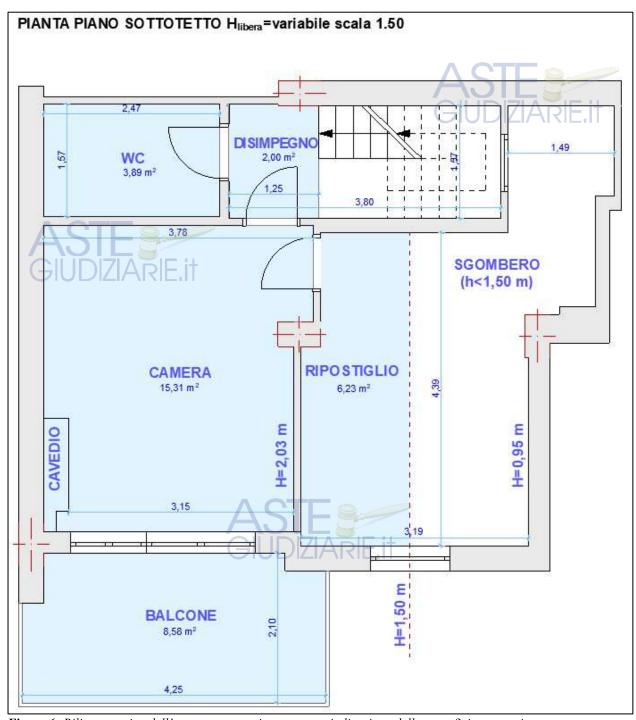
Rilievo metrico dell'appartamento pignorato con indicazione delle superfici nette – piano sottotetto.
